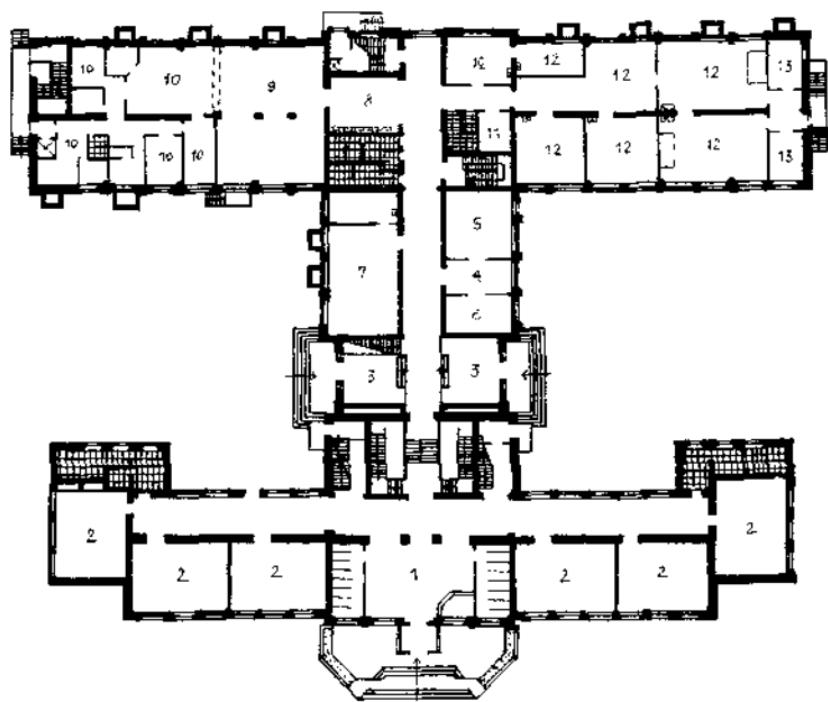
План первого этажа реконструированной общеобразовательной школы:
